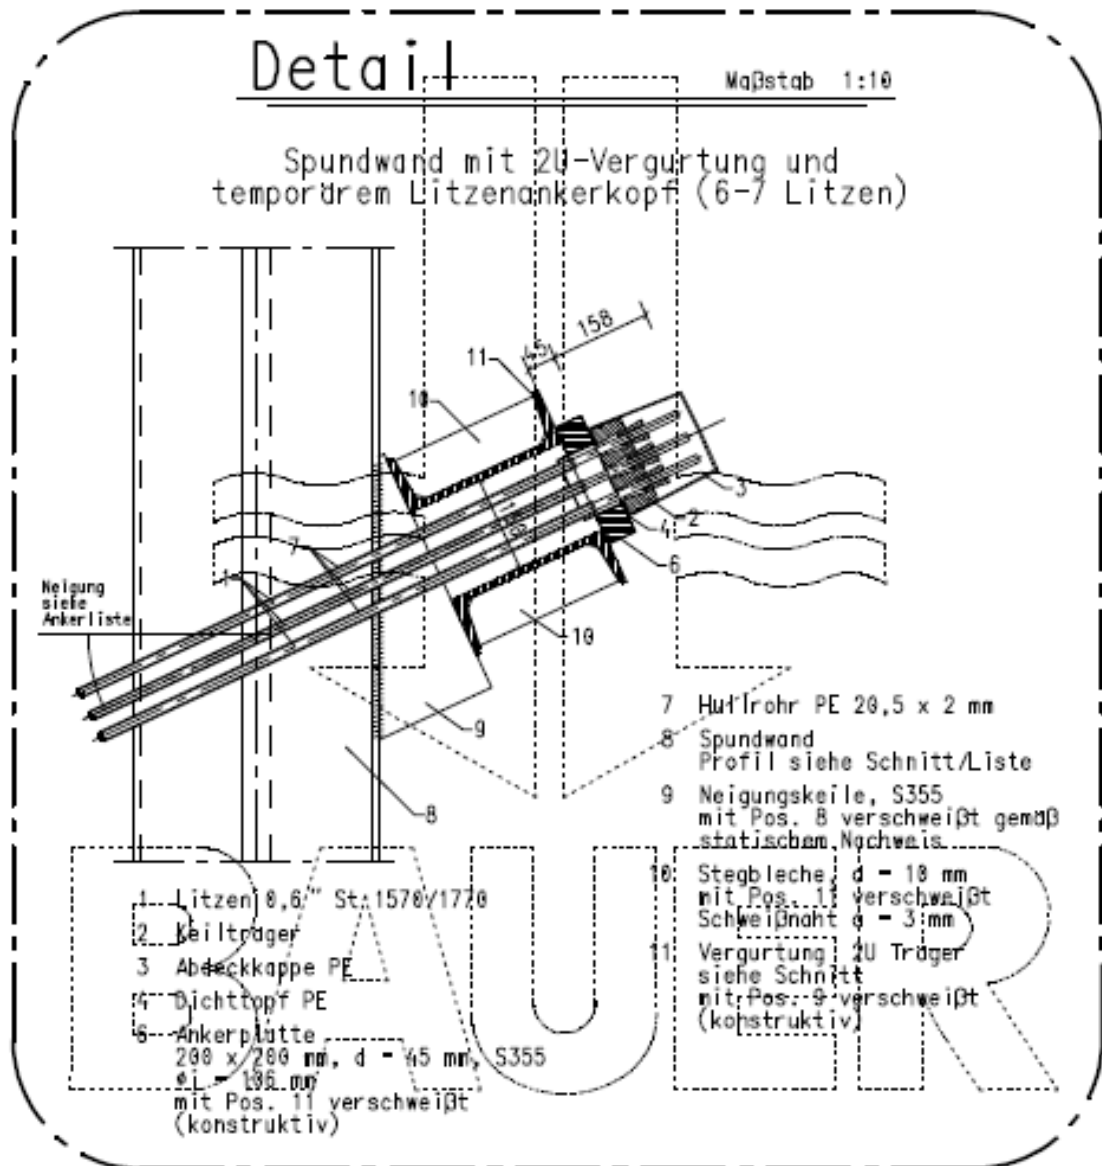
Конструкція ґрунтоцементного анкера фірми "Bauer"
